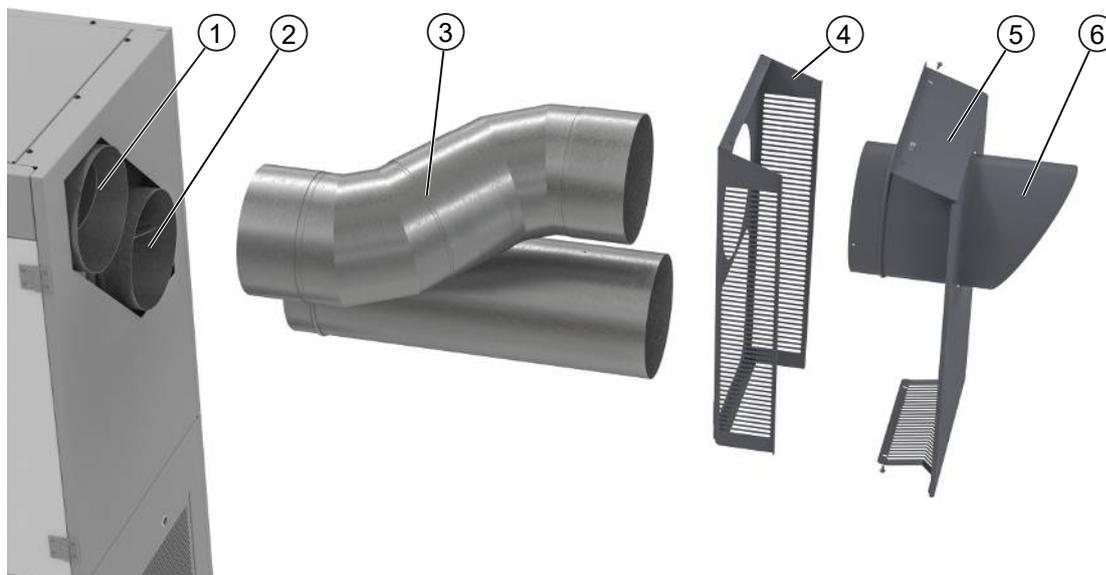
Rohrverbindung zum Fassadenanschluss herstellen
